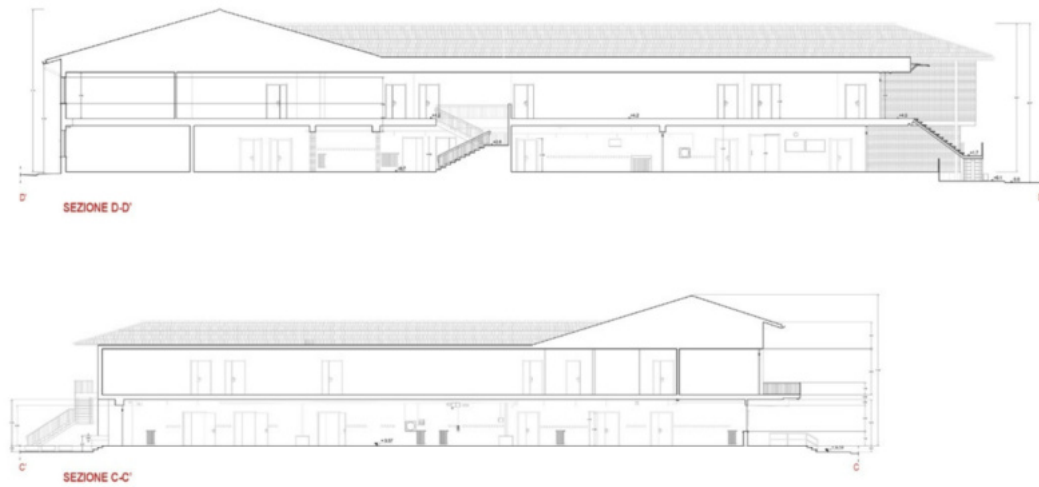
Sezioni longitudinale C-C' e trasversale D-D'
